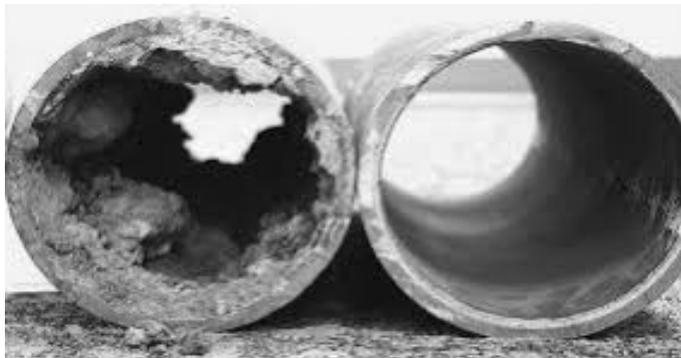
Фрагмент трубопровода с отложениями и без них
